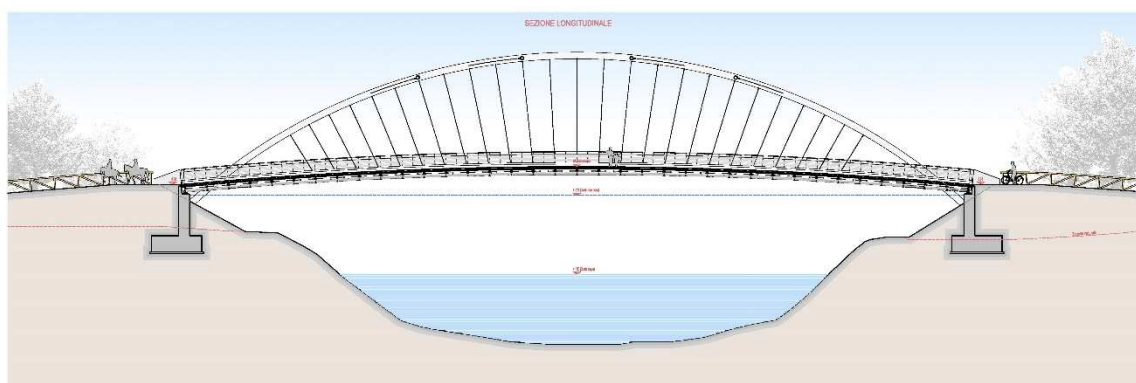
Sezione longitudinale del ponte secondo il progetto preliminare redatto dal Comune di Grosseto
